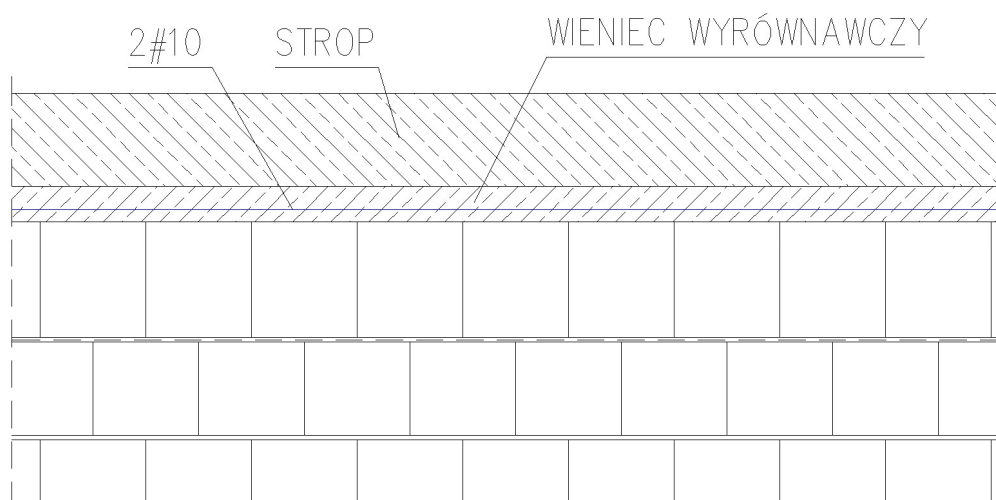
Schemat zbrojenia ścian murowanych nośnych
